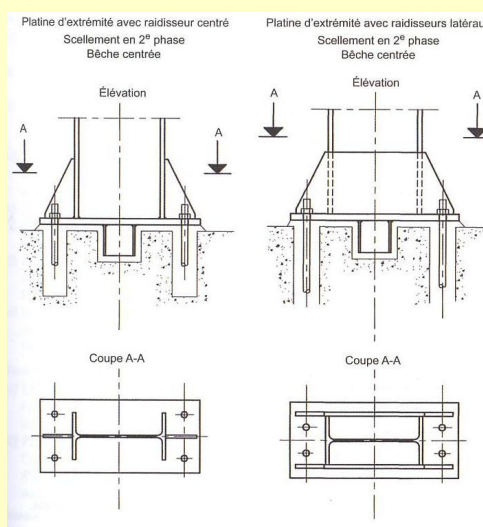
Pieds de poteaux encastrés avec platine d'extrémité.
